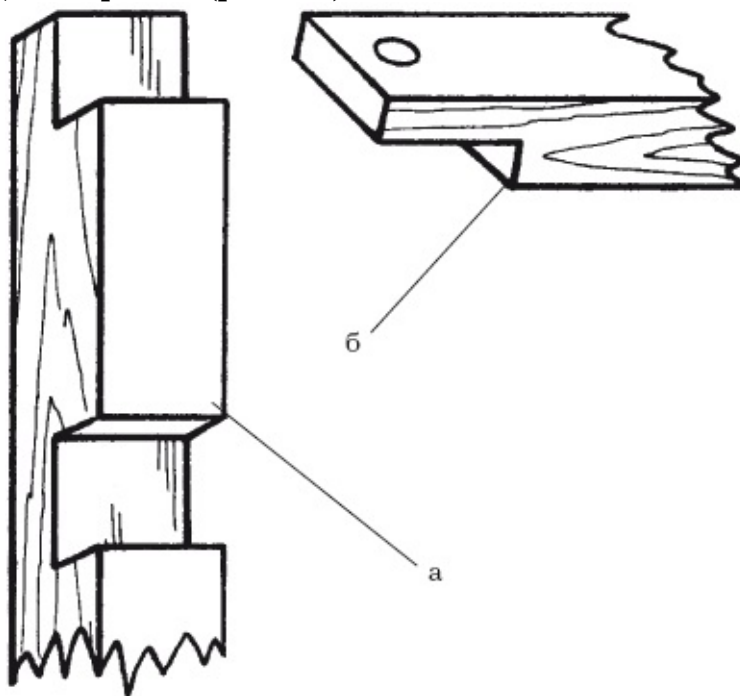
Крепление брусков дверного полотна: а– горизонтальный брусок; б – вертикальный брусок
